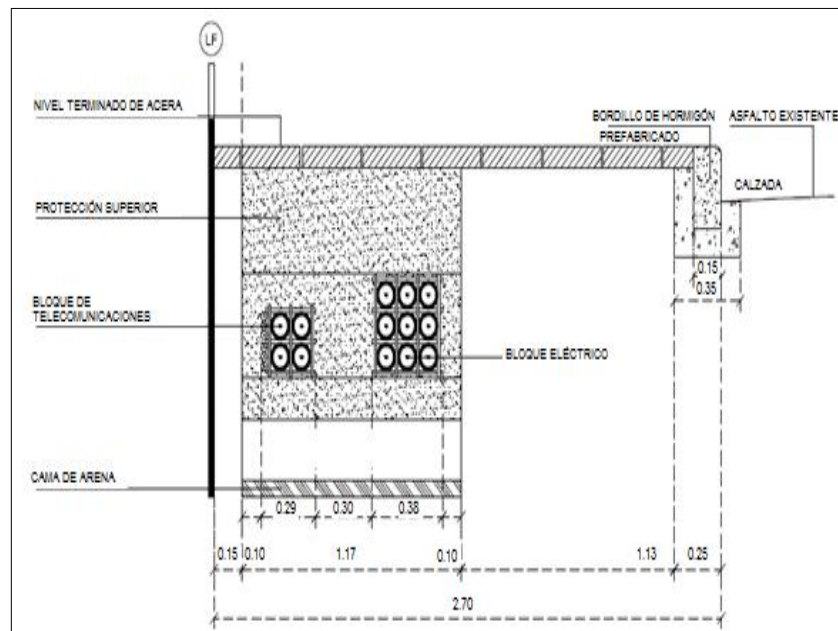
Colocación de ductos de PVC en acera estándar
